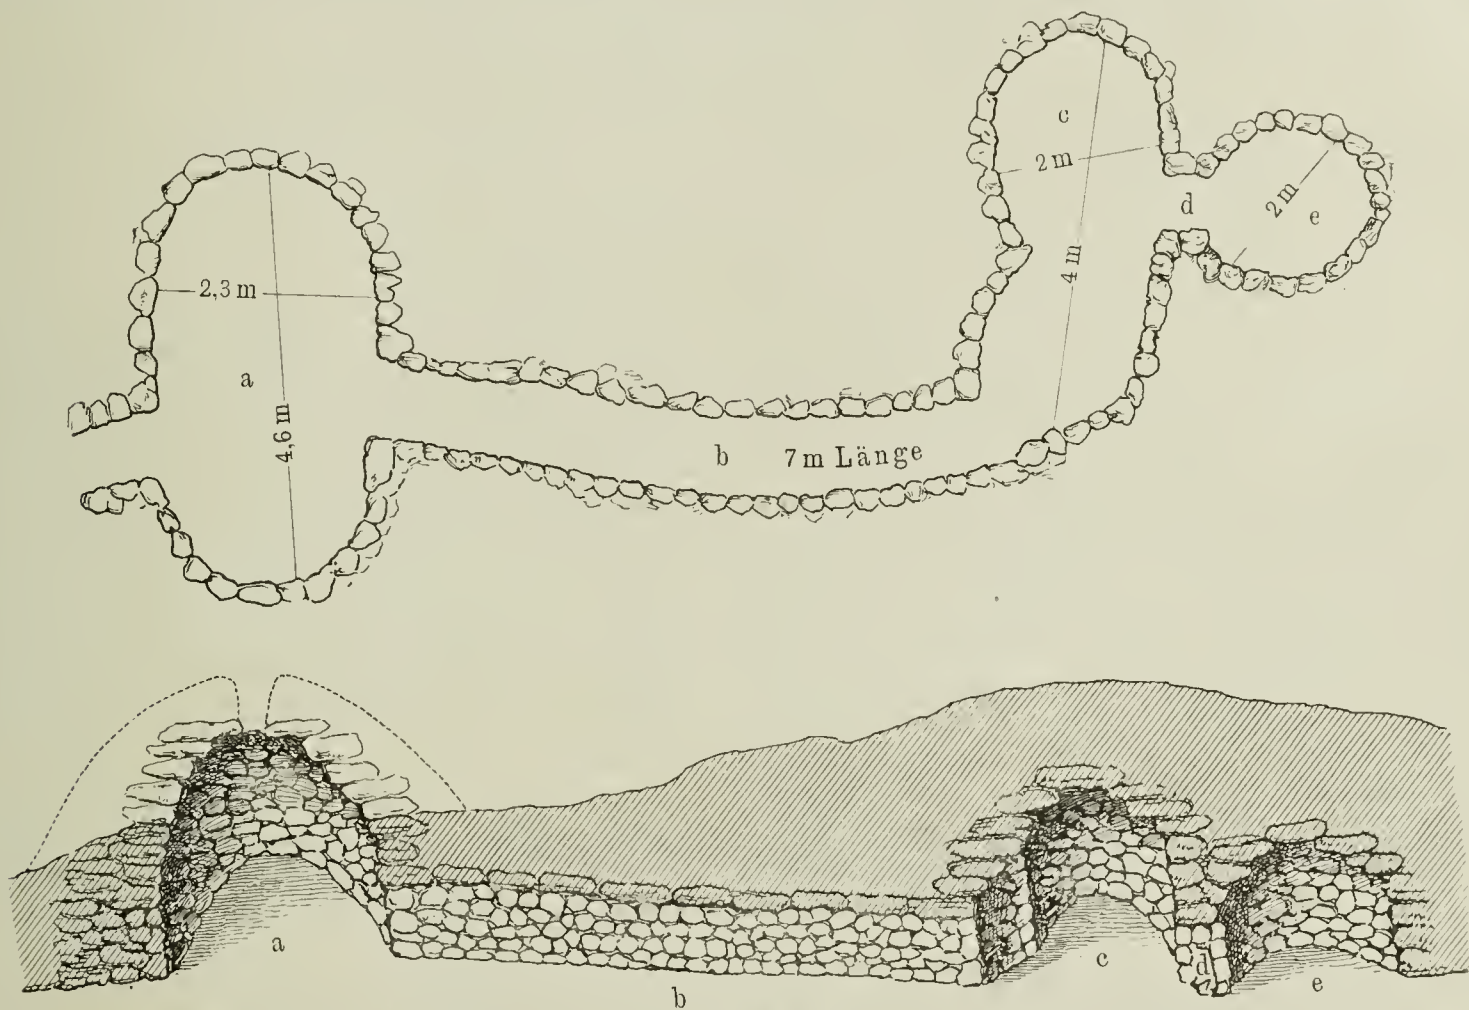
Grundriss und Längsschnitt durch „The Mound of the Cave“ (South Uist, Schottland).
